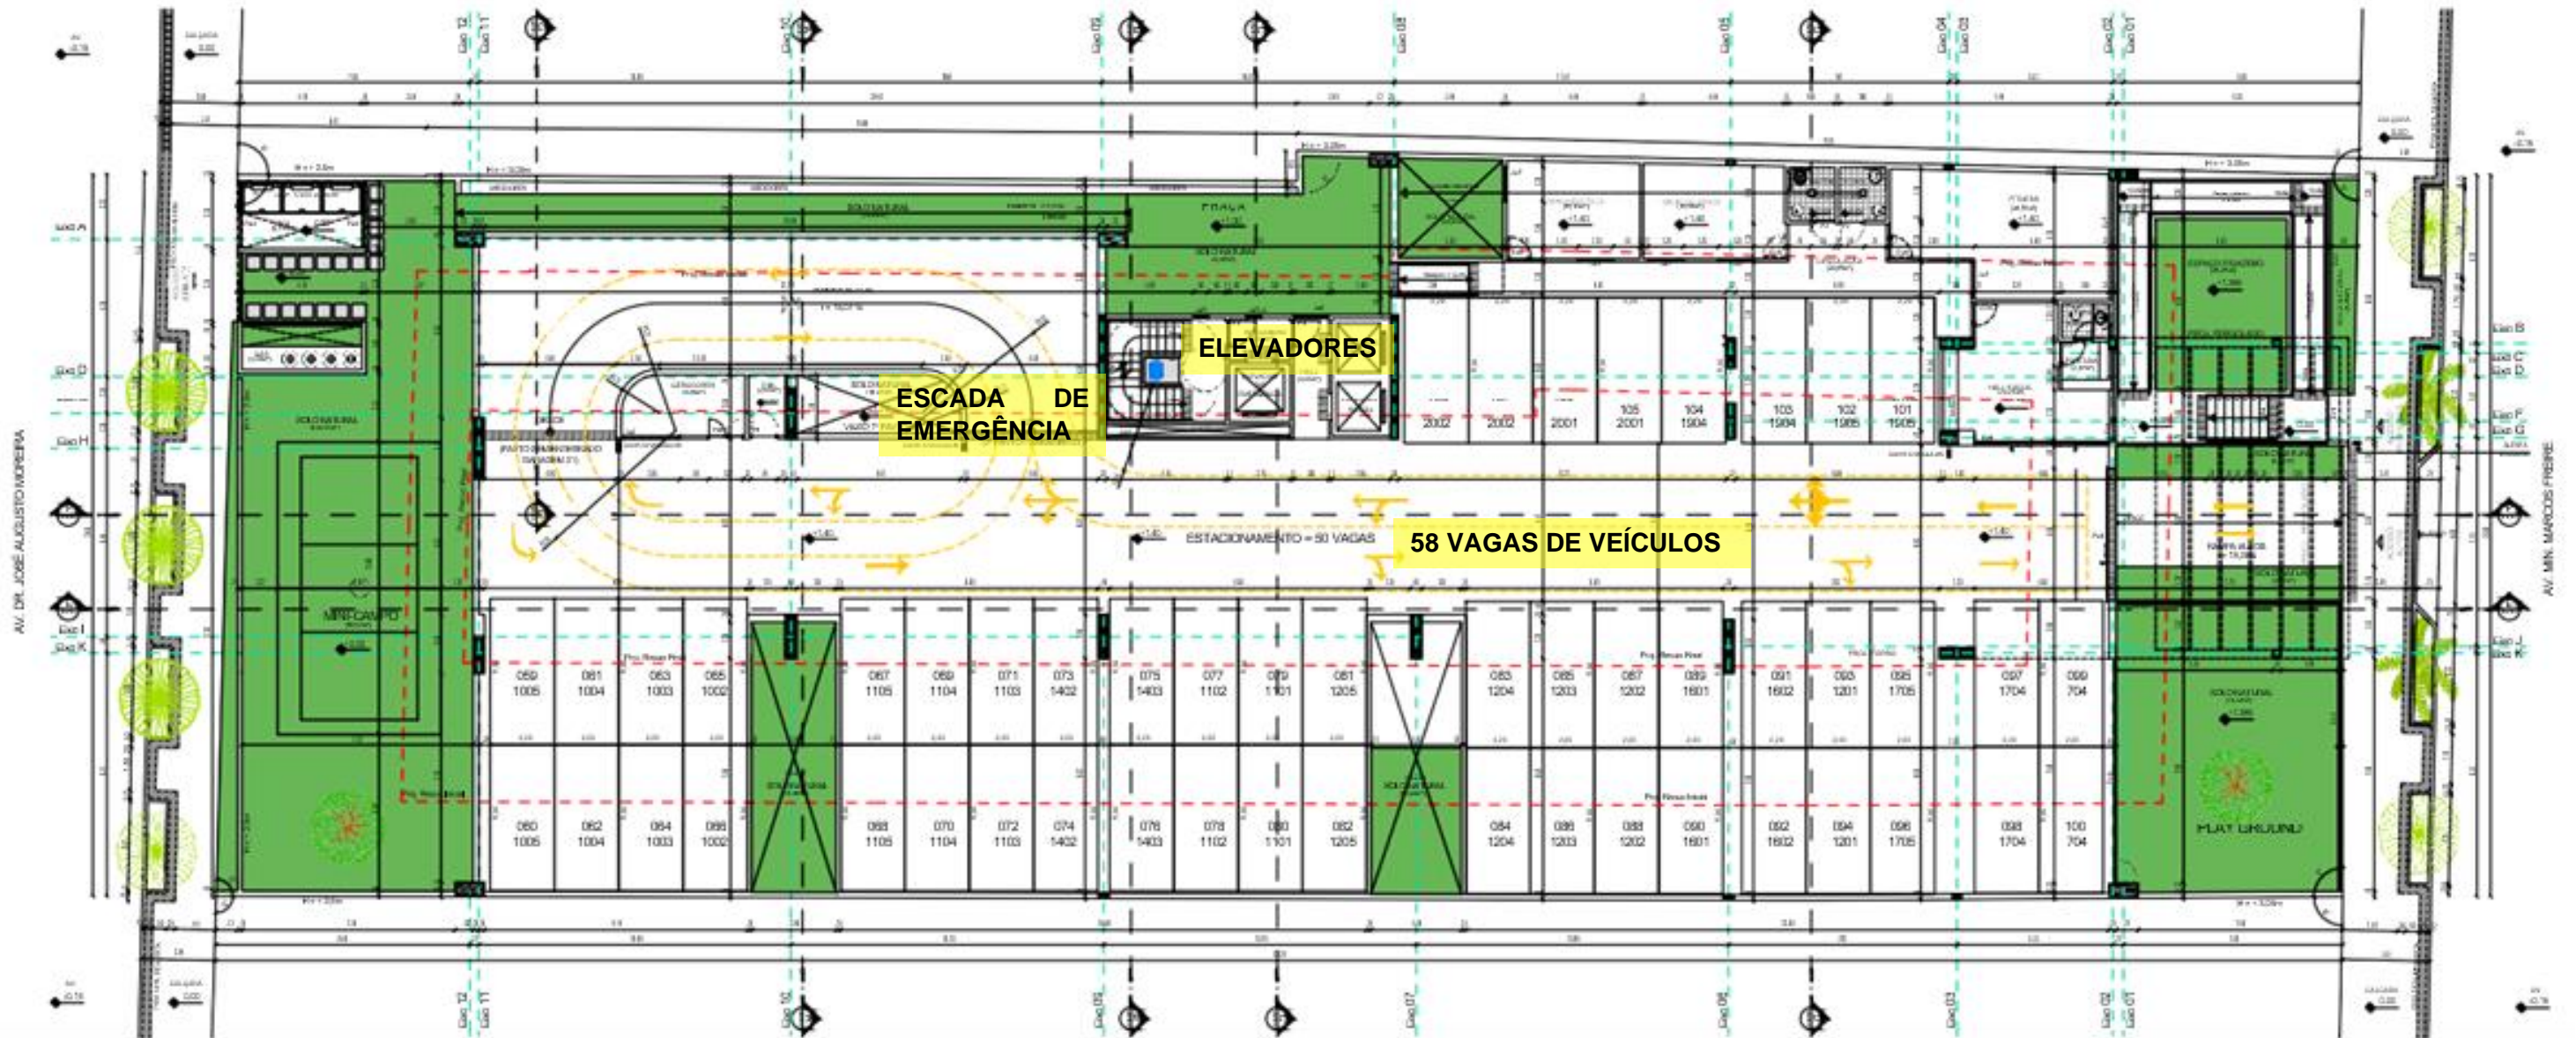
Planta Baixa PAV. TÉRREO – G2 – P03.13.
